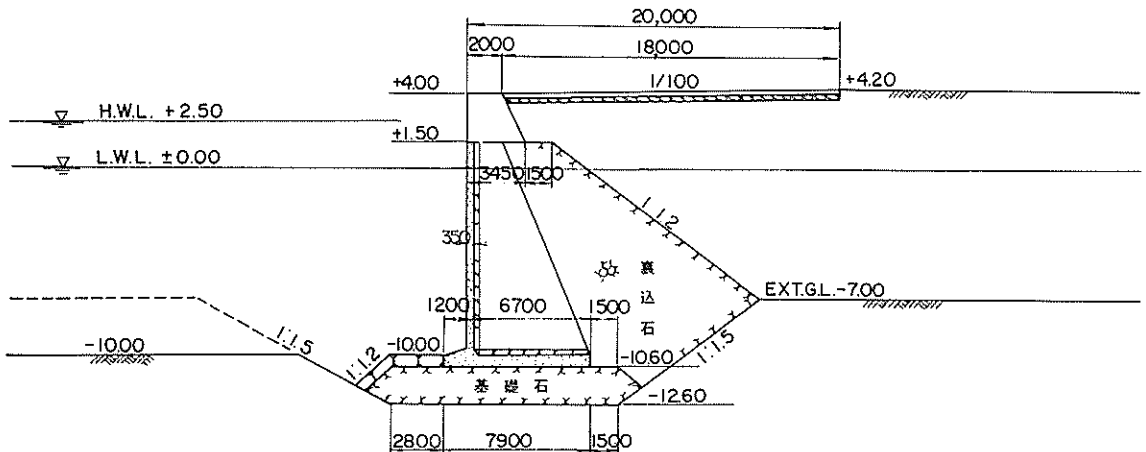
L型ブロック式-10.0m岸壁標準断面図(タイプD-6)
